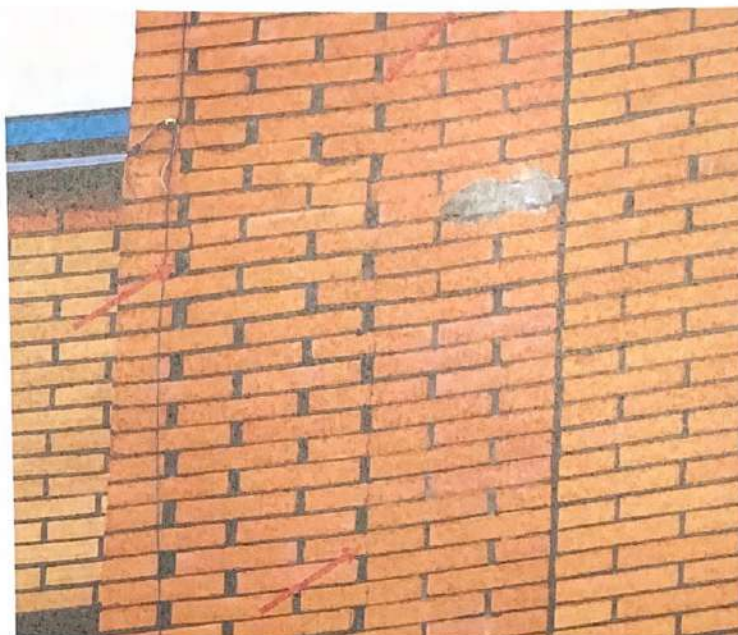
Секция 12. Фасад 2. Трансэтажные вертикальные трещины по левой стороне подъездного выступа. Дефекты исходной кладки – пустошовка, сверхнормативные швы являются признаком нарушения геометрии кладки.
